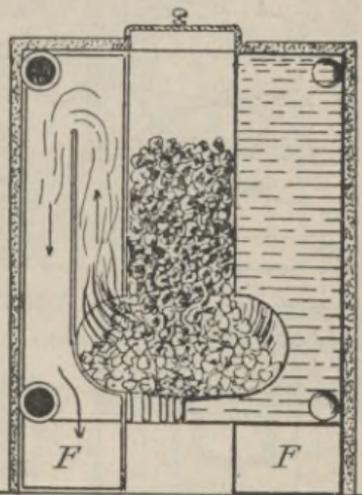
Gußeiserner Gliederkessel mit unterem Abbrand (Körting).
